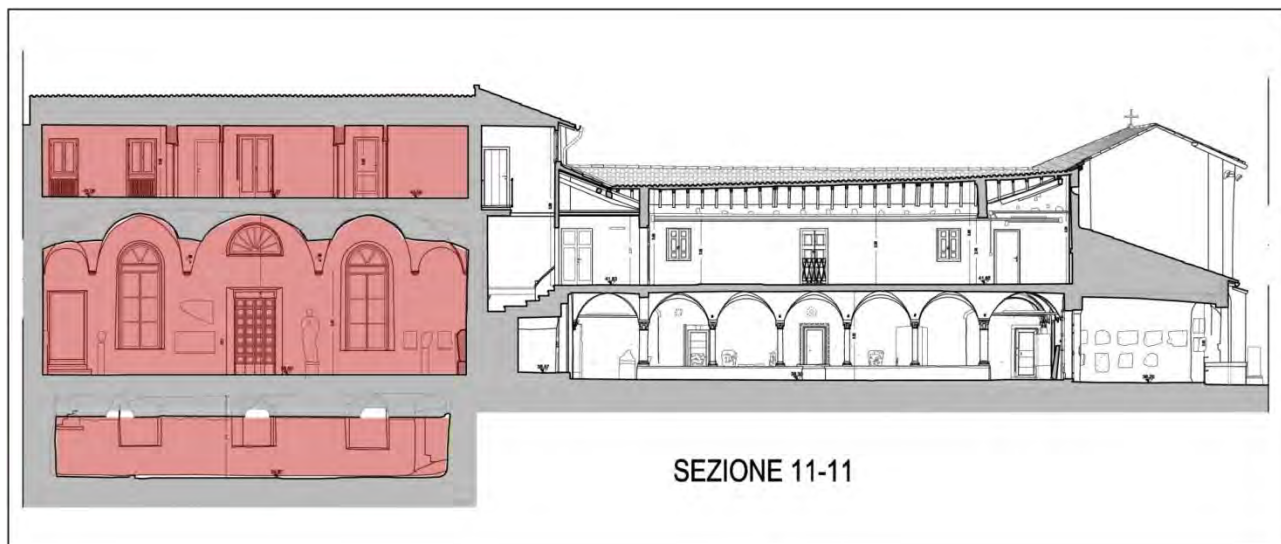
3 - sezione 11-11, individuazione U.S.
